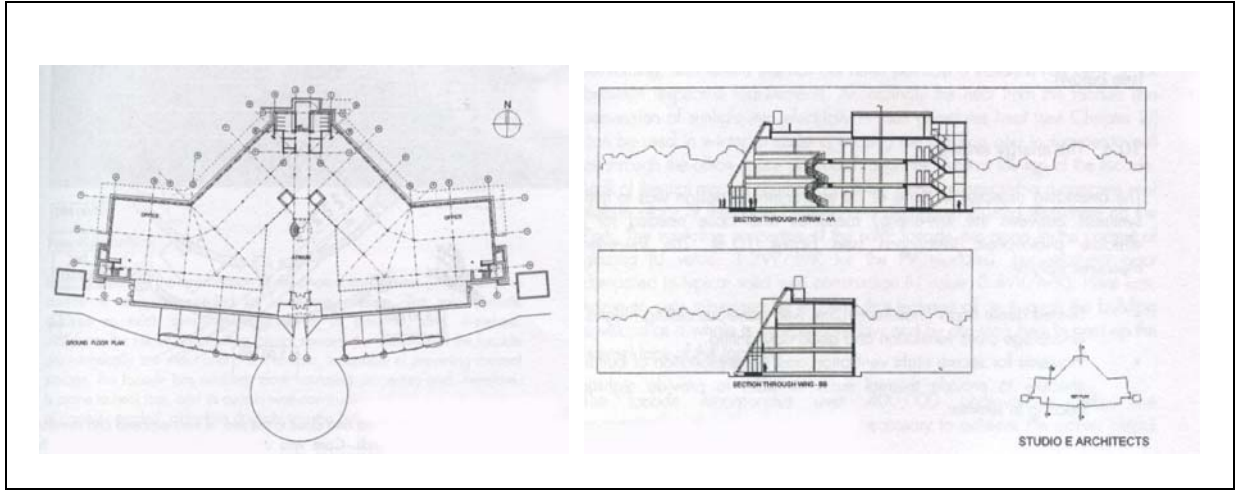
13 Vaziyet planı ve genel görünüşü [14]
